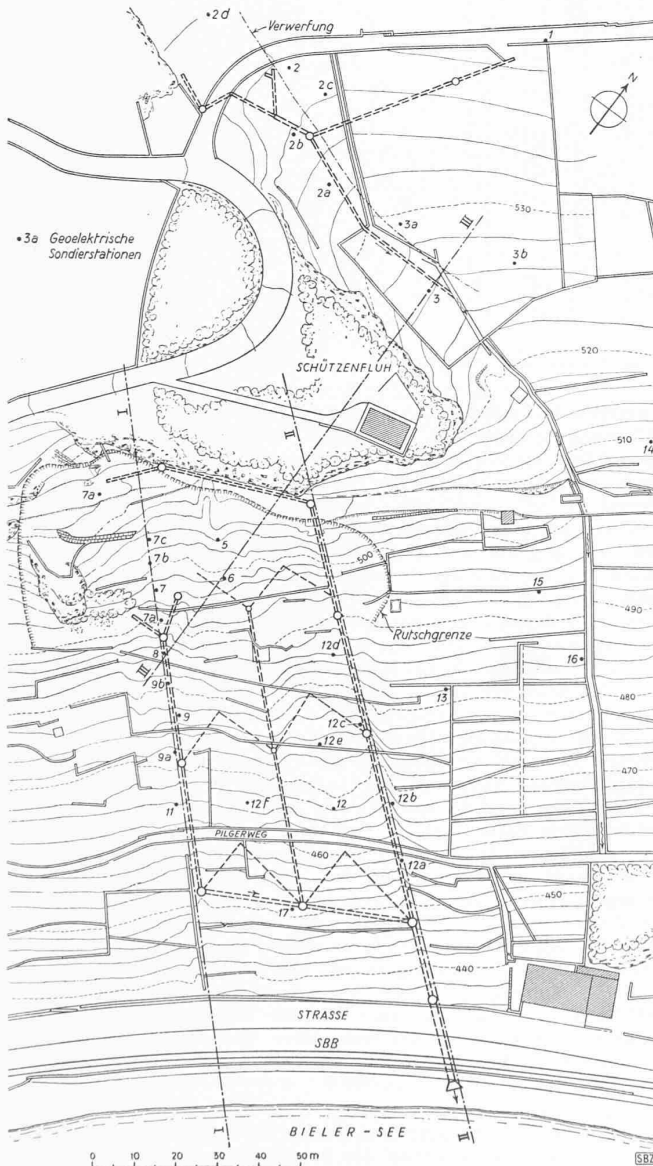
Lageplan der Rutschung bei Ligerz, mit Sondierprofilen und Eintragung der durchgeführten Entwässerung
